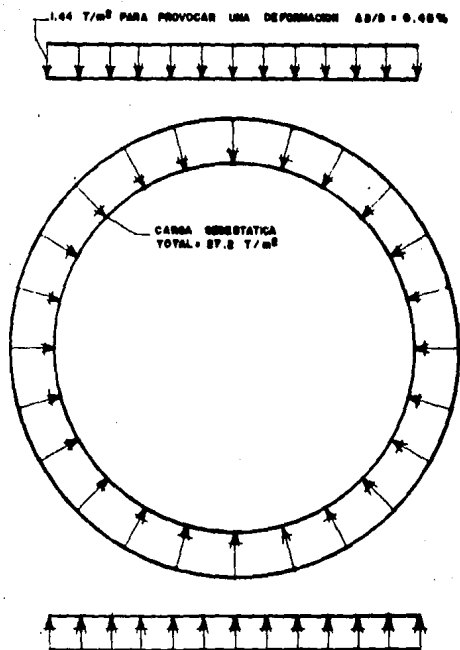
CARGAS RADIAL Y UNIFORME CONSIDERADAS
